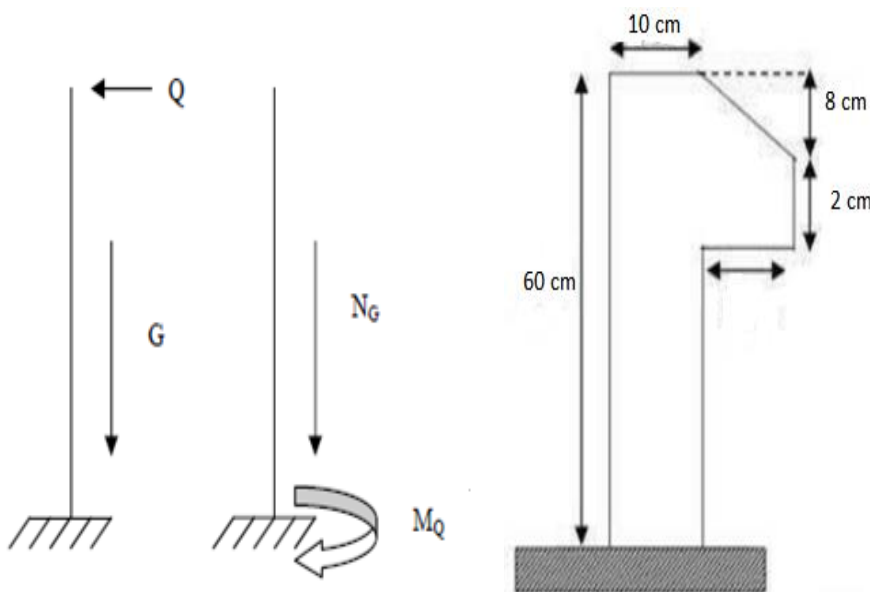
Schéma statique d'acrotère. Figure IV-2 : Coupe transversale de l'acrotère.
